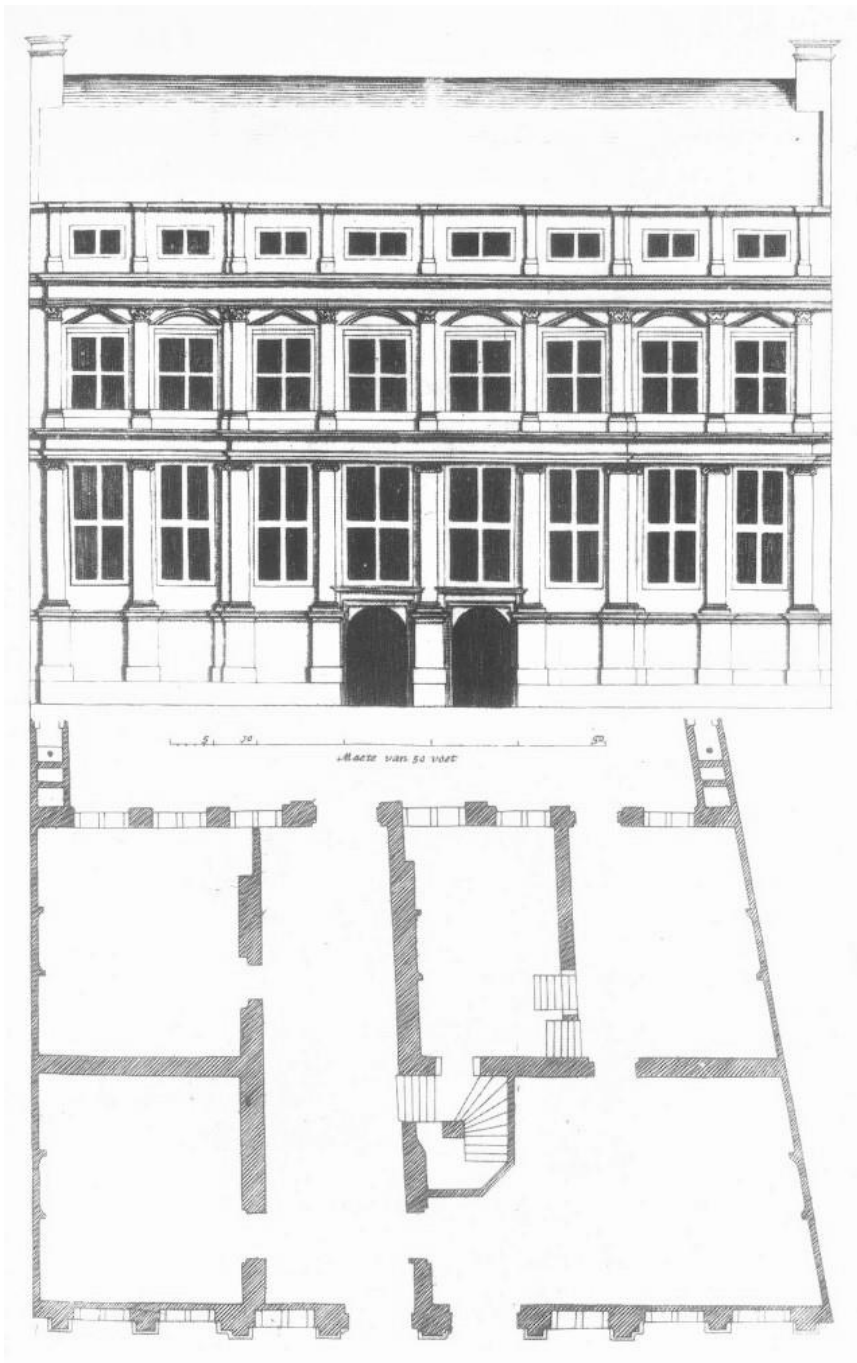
Jacob van Campen: *Coymanshuis*, Ansicht/Grundriss, Amsterdam, 1625
